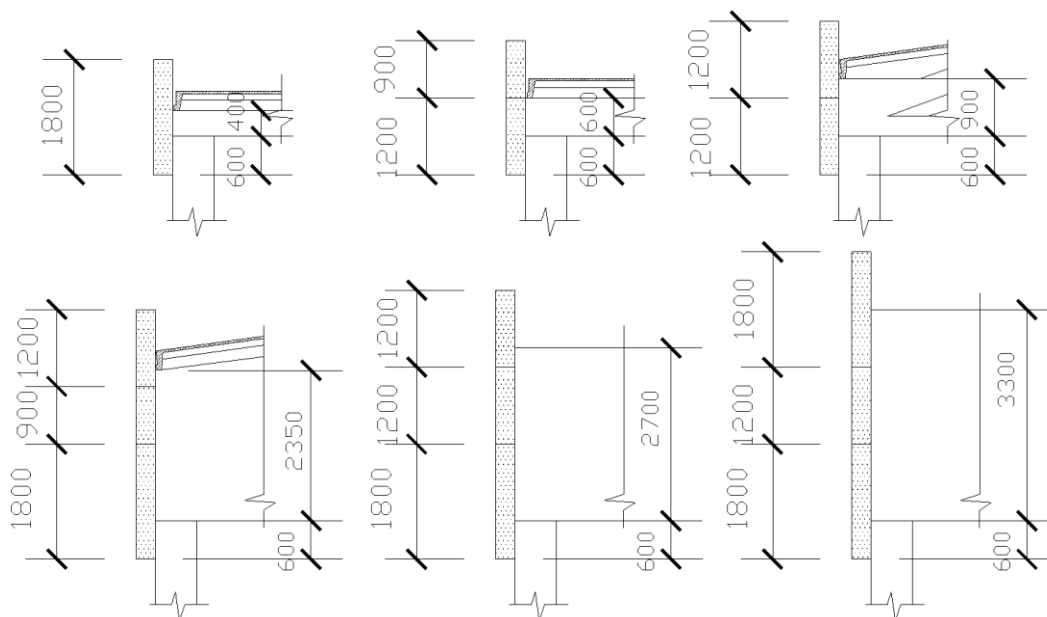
Компонка верхней части панельных стен с парапетом при различной высоте опорной части стропильных конструкций покрытия
